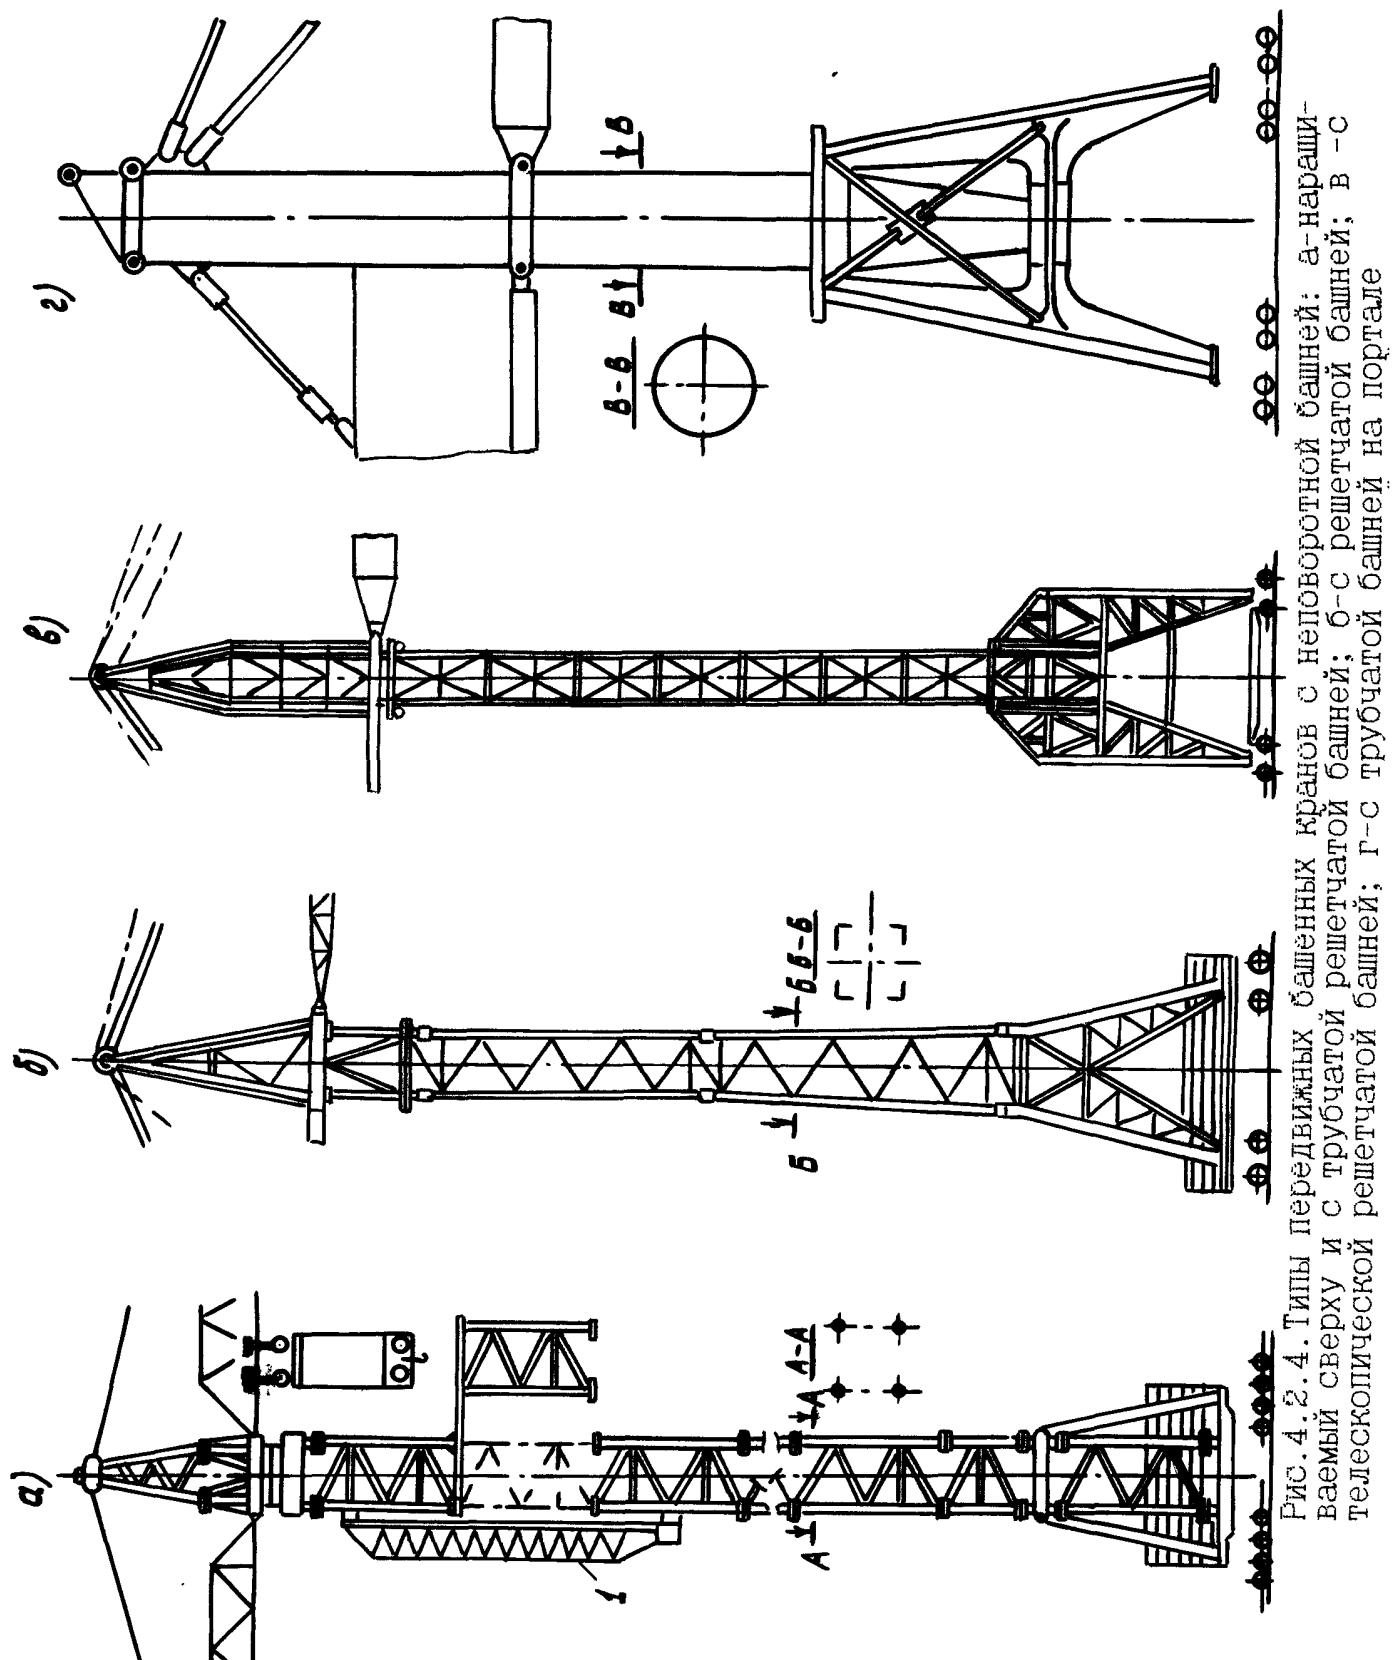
Типы передвижных башенных кранов с неповоротной башней: а - нарашиваемый сверху и с трубчатой решетчатой башней; б - с решетчатой башней; в - с телескопической решетчатой башней; г - с трубчатой башней на портале
